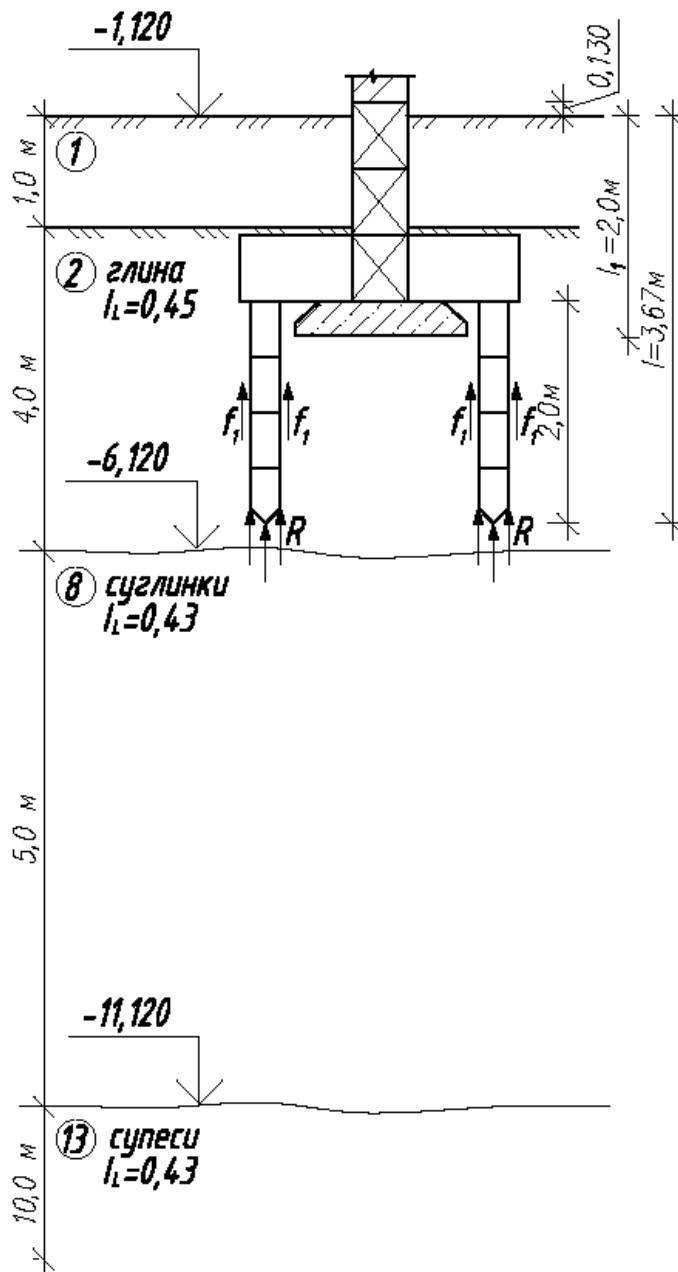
Разрез грунтовой толщи по свае
